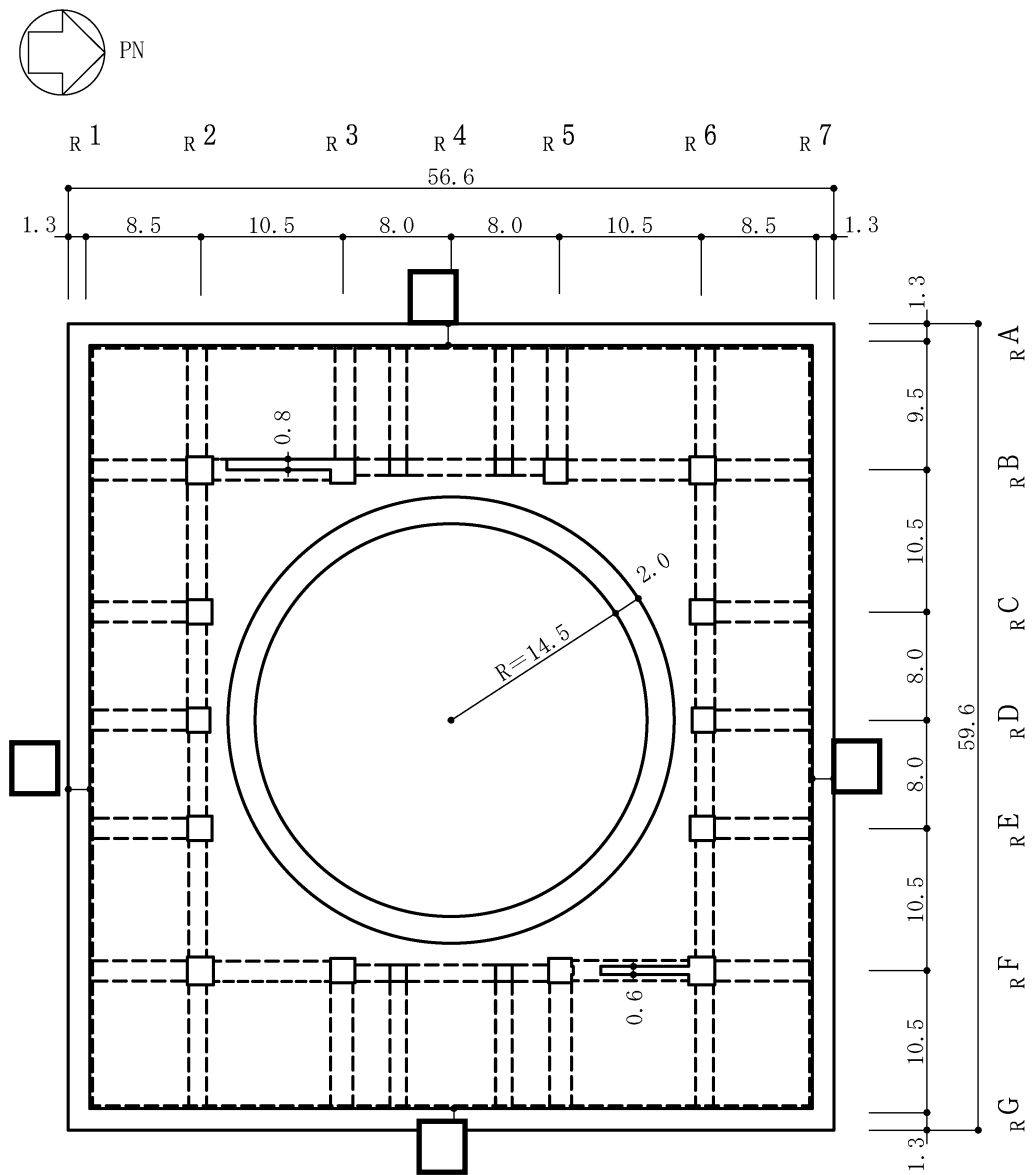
原子炉建屋の概略平面図 (B2F, T.M.S.L. -1.7m) (単位 : m) (2/9)
